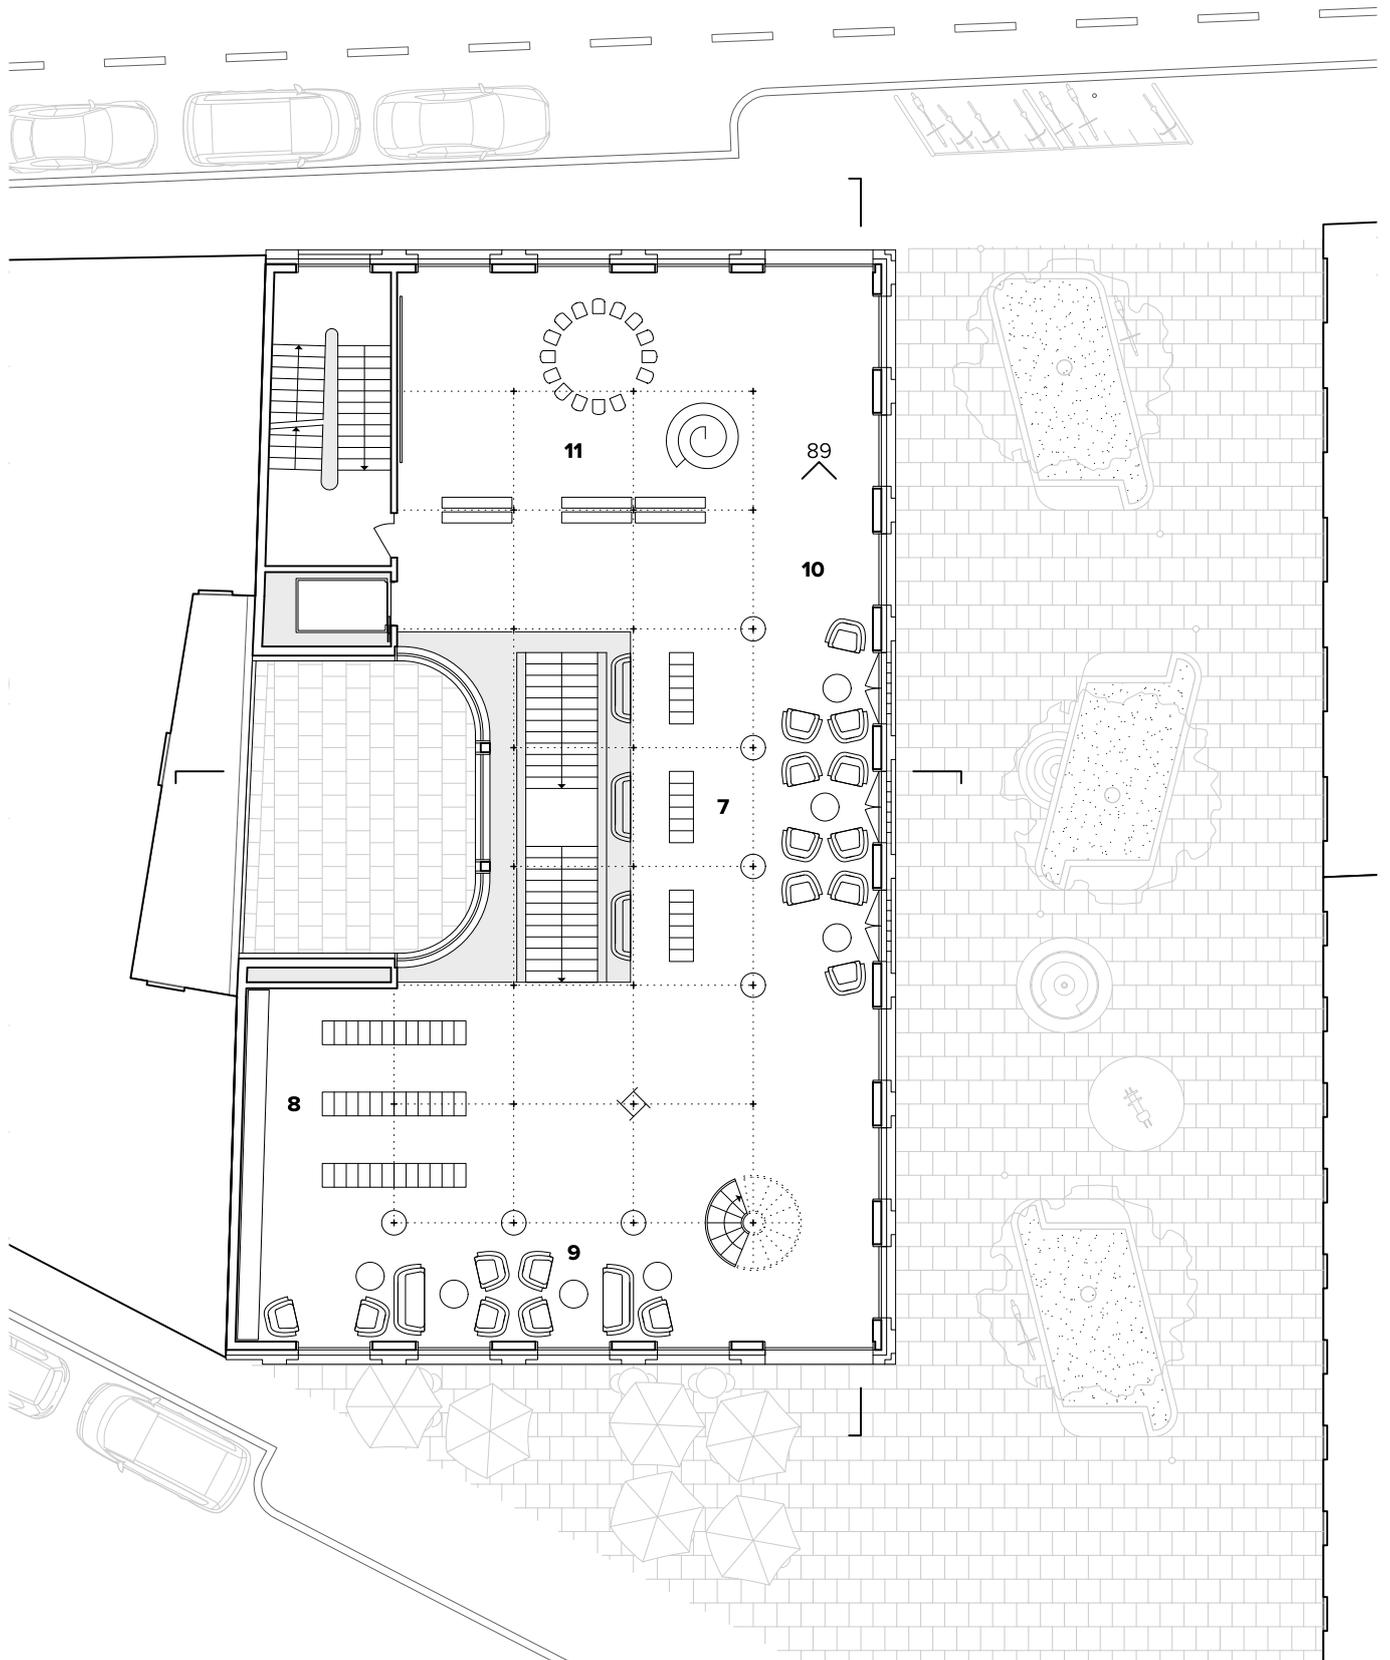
Grundriss 1. Obergeschoss 1.200 (BM)
